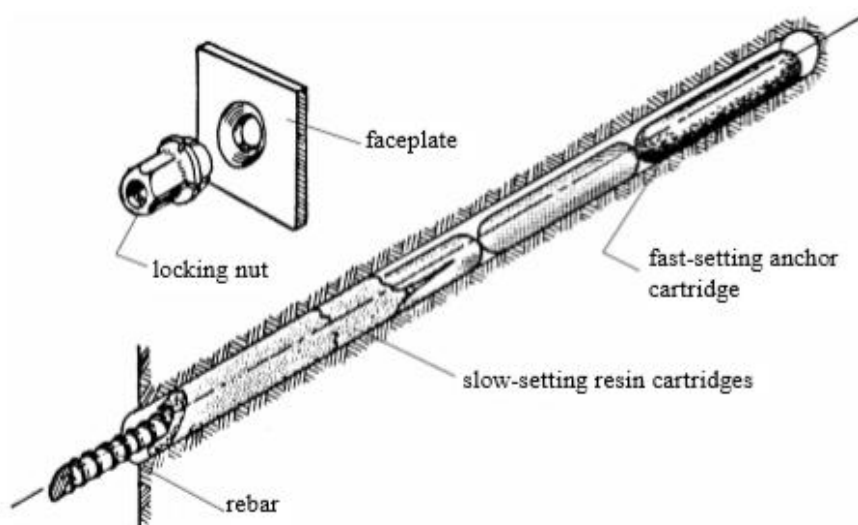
Elementos básicos de ancoragem de tirantes (modificado de Windsor, 1996).
